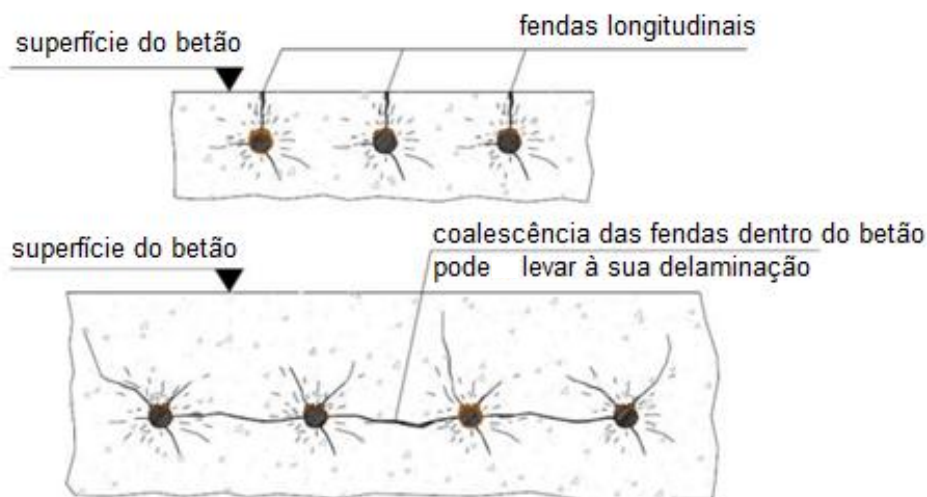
Abertura de fendas e delaminação do betão de recobrimento devido à corrosão das armaduras. (adaptado de (Cavaco 2013))
